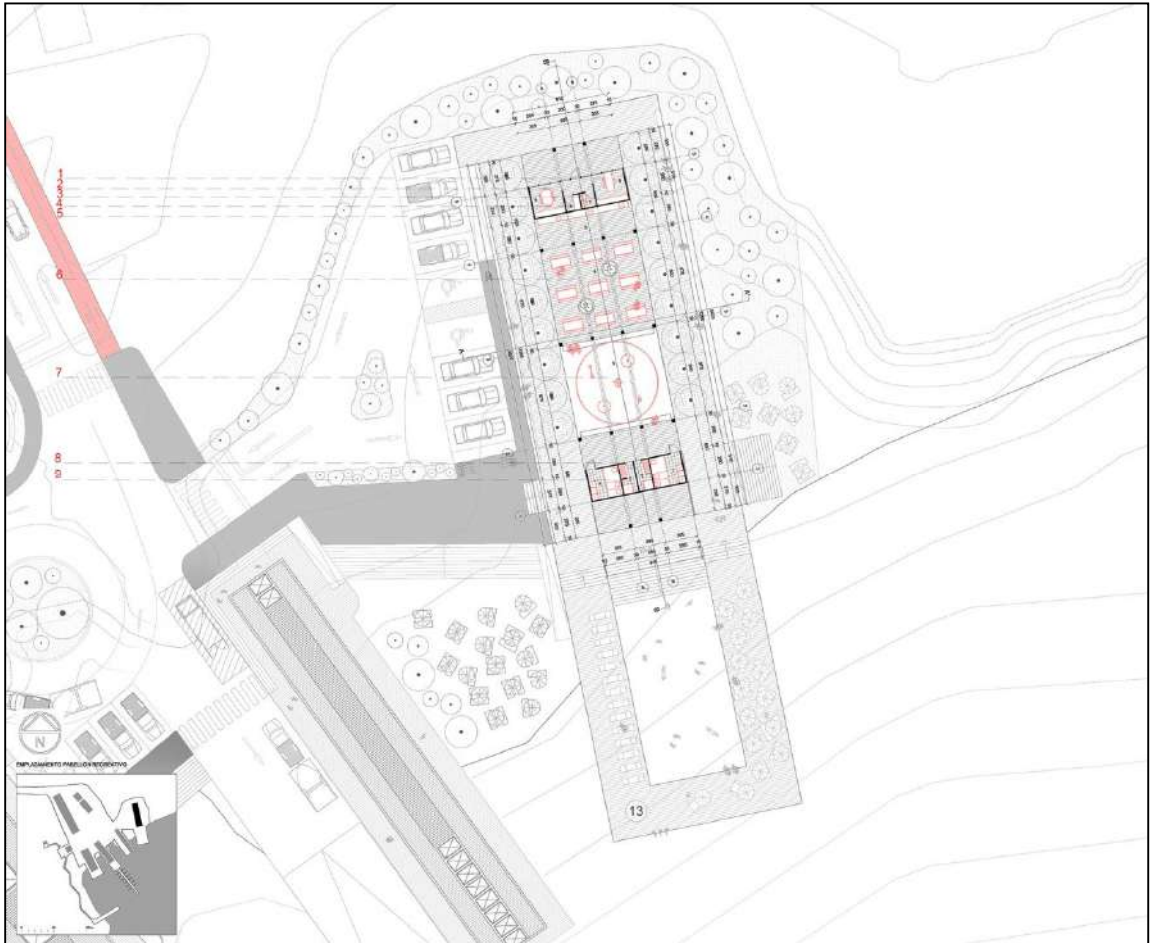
PLANTA EDIFICIO PABELLÓN RECREATIVO
